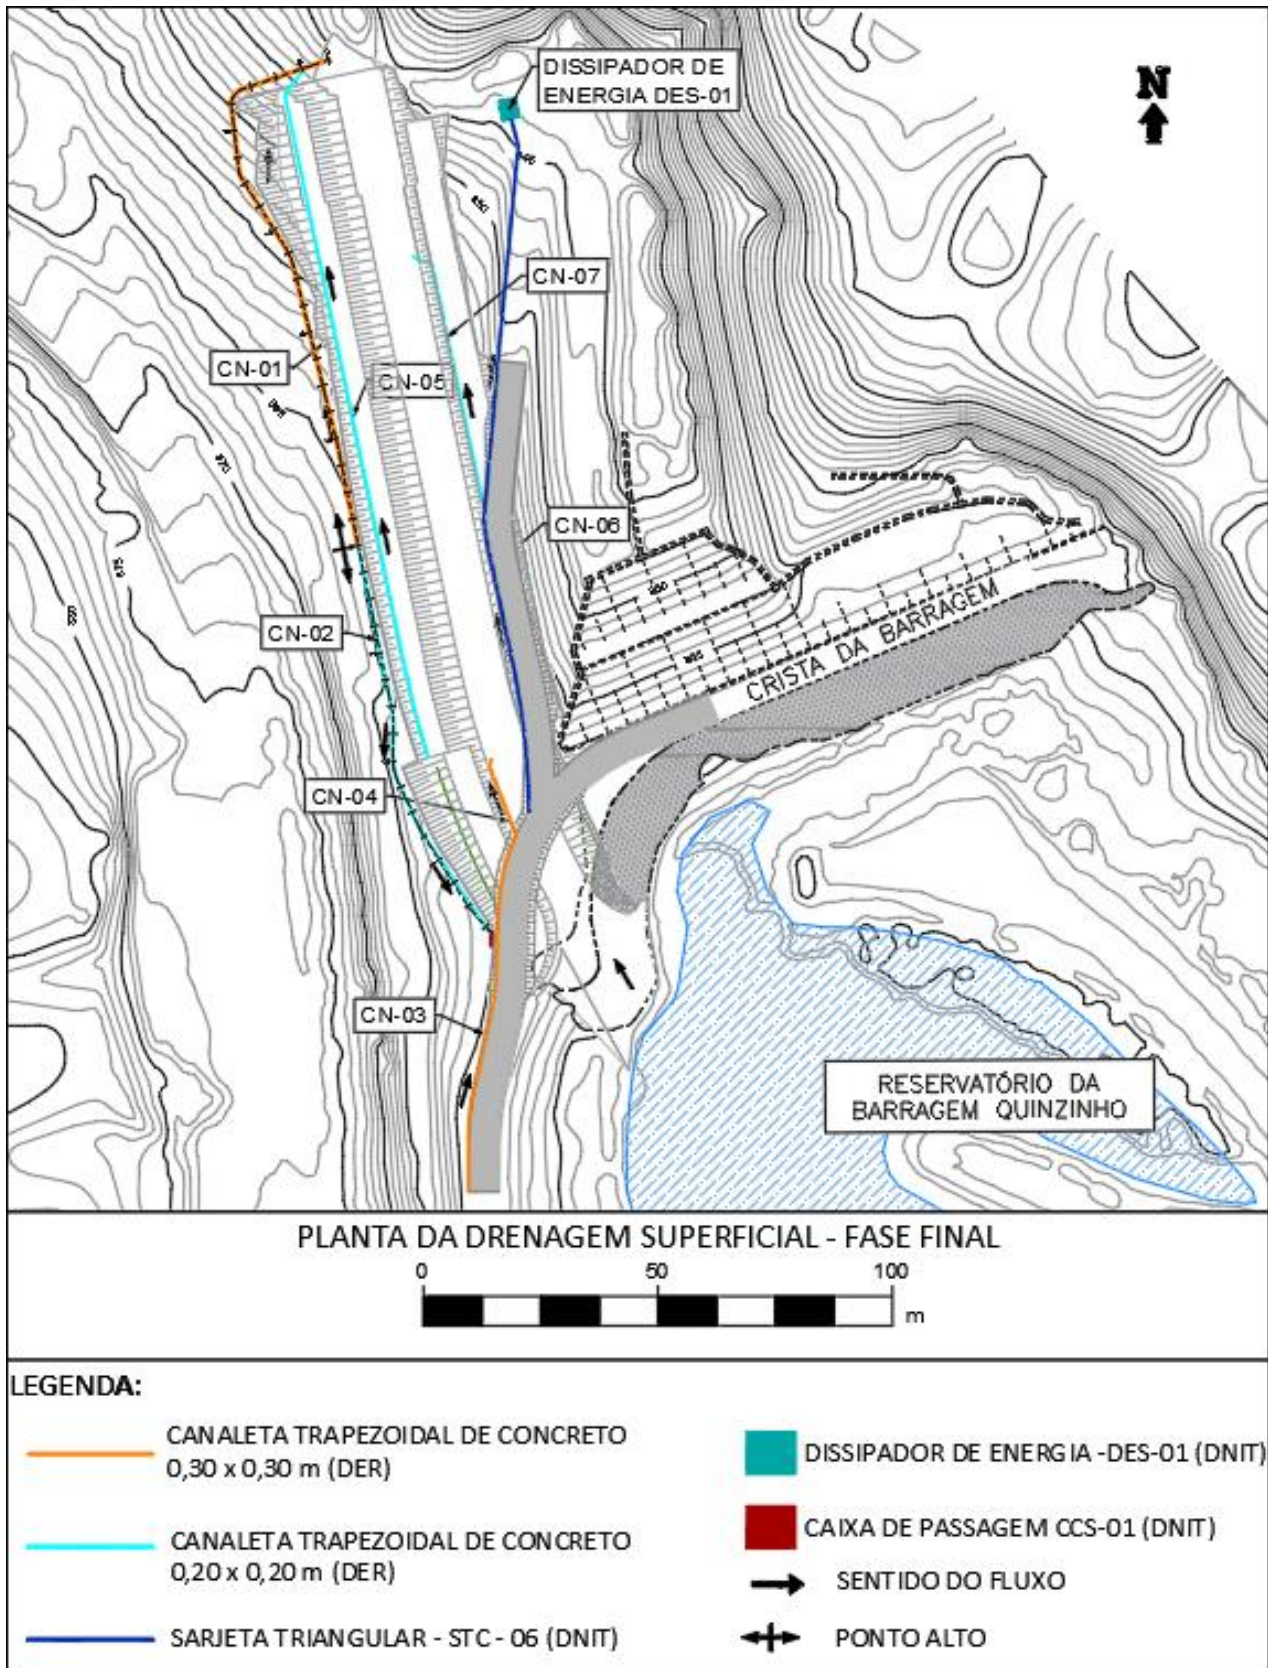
Sistema de Drenagem Superficial - Planta.
